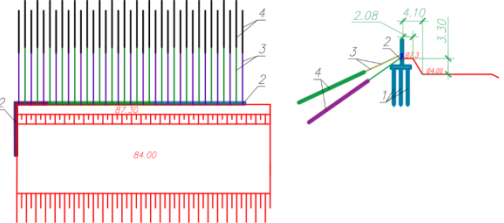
Вертикальная привязка свайных фундаментов в инженерно-геологический разрез: 1 – свайное основание из призматических железобетонных свай под существующий
